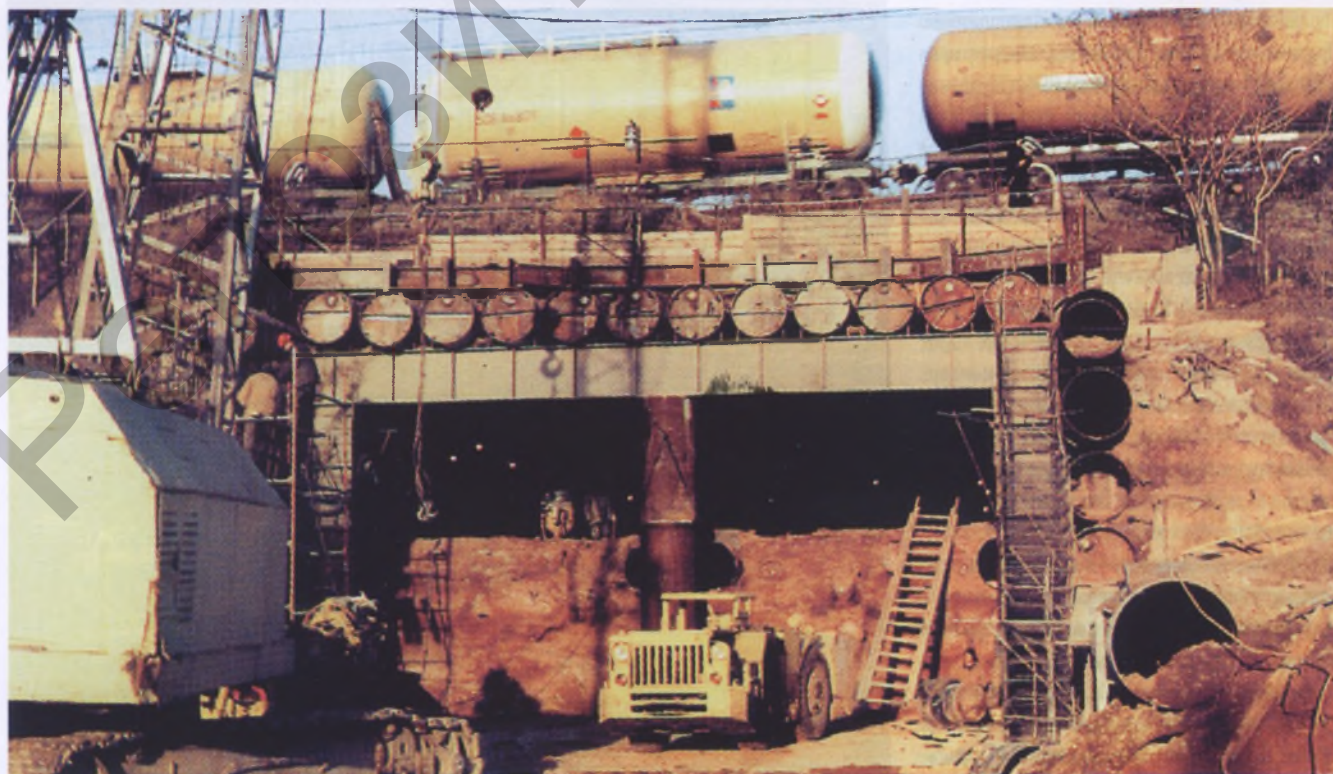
Строительство автодорожного тоннеля под защитой опережающего экрана из стальных труб в Перми
